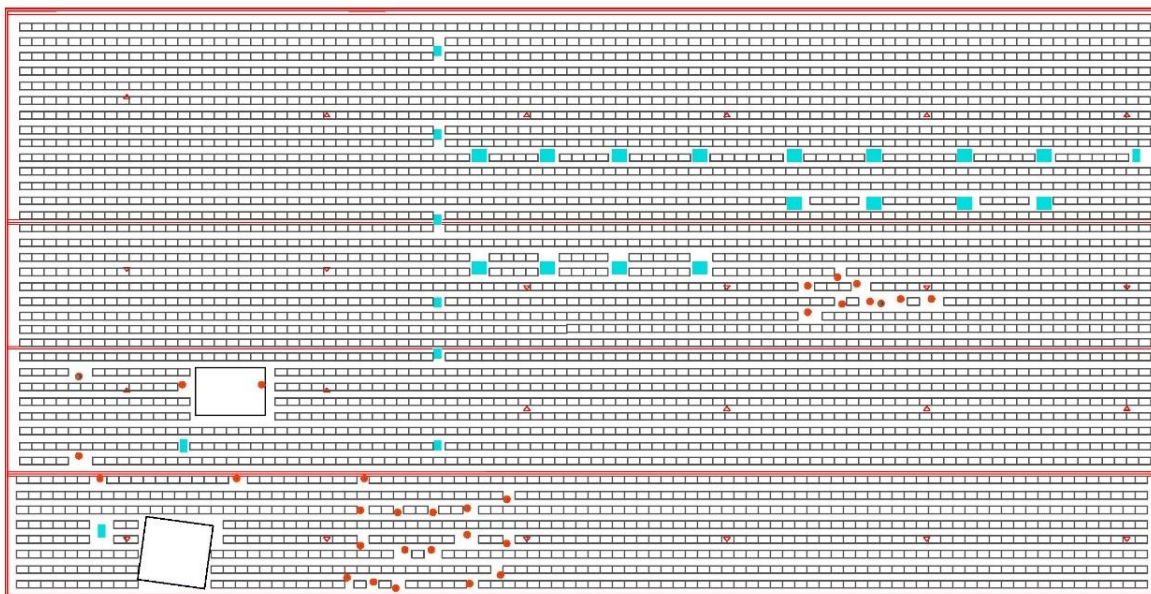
Disposição de 3477 painéis na horizontal com 1 metro entre fileiras
